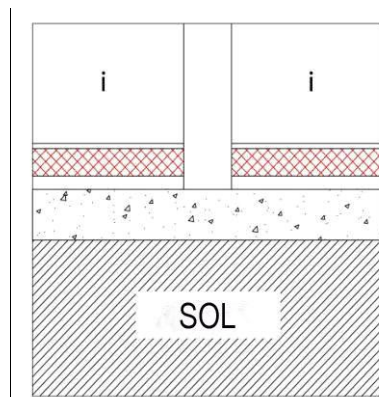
Des murs intérieurs sur un plancher sur sol ne doivent pas être considérés comme des nœuds constructifs linéaires.
